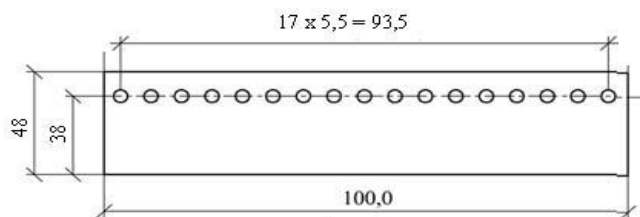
Конструкція перерізу плити з додатковою арматурою
